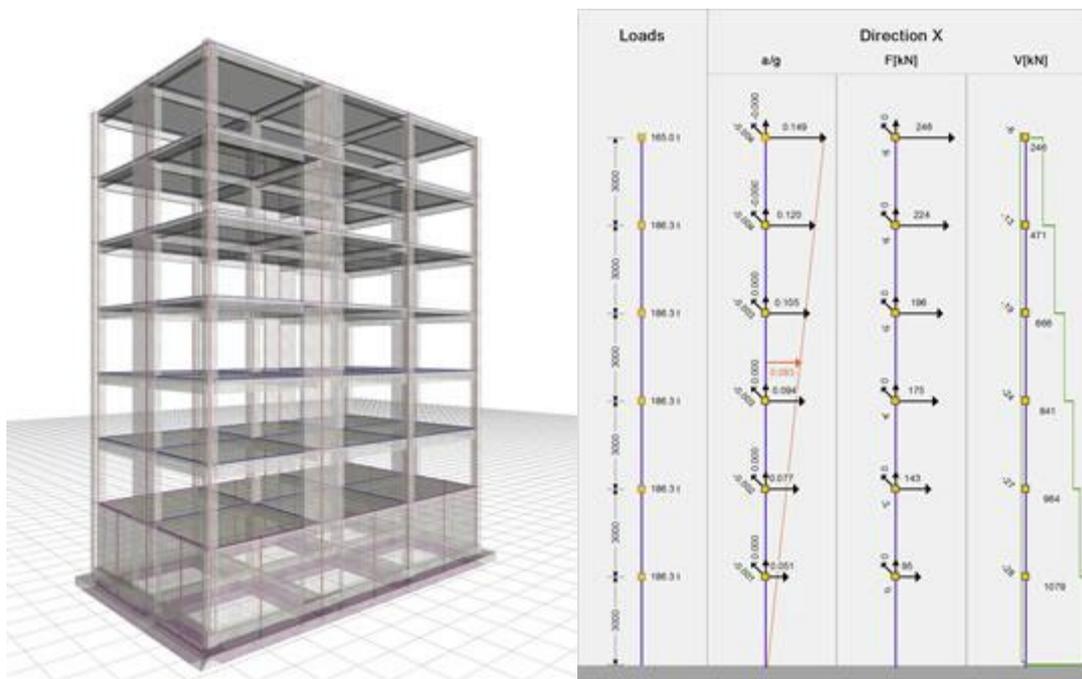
Схема конструкції будівлі з зовнішніми стінами та підвальним поверхом, що охоплює всю площу основи
